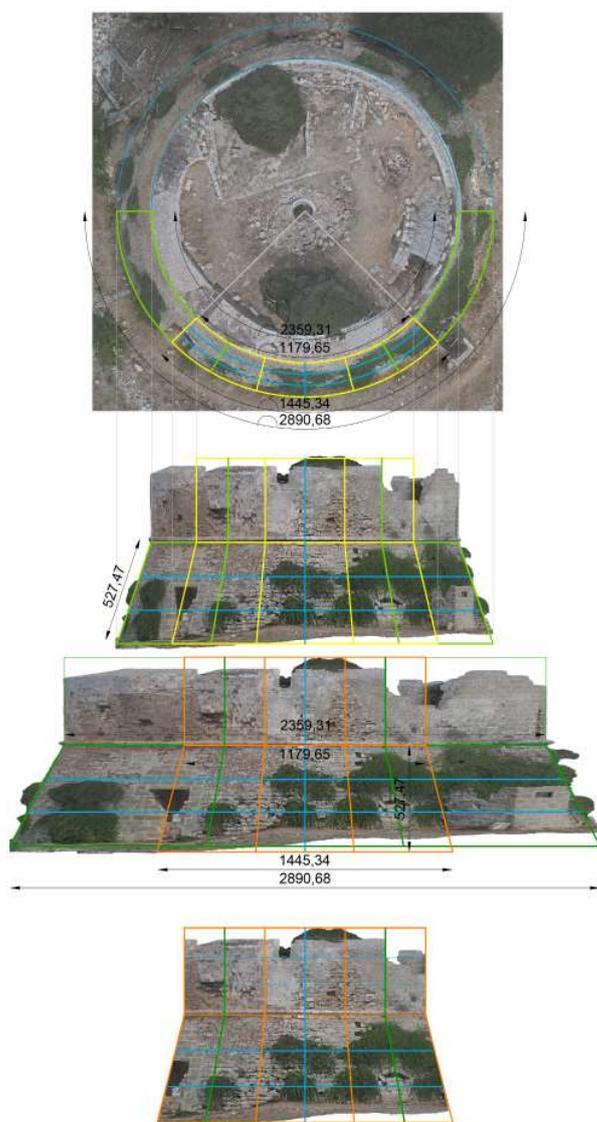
Distorsione prospettica applicata in senso longitudinale ai prospetti con l'ausilio del reticolo: prospetto Sud.
